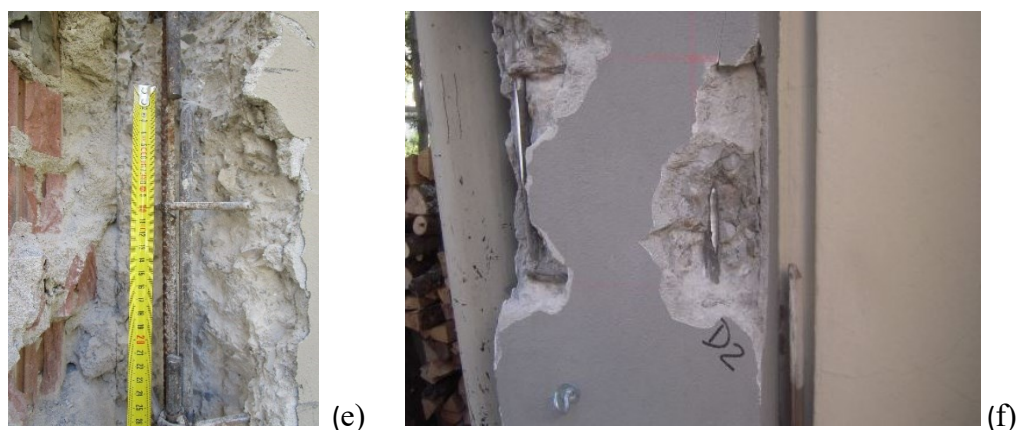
Prelievo di barra da pilastro del piano terra individuato in pianta con cerchio giallo (e); prova con microdurometro su pilastro del piano terra individuato da cerchio viola (f).
